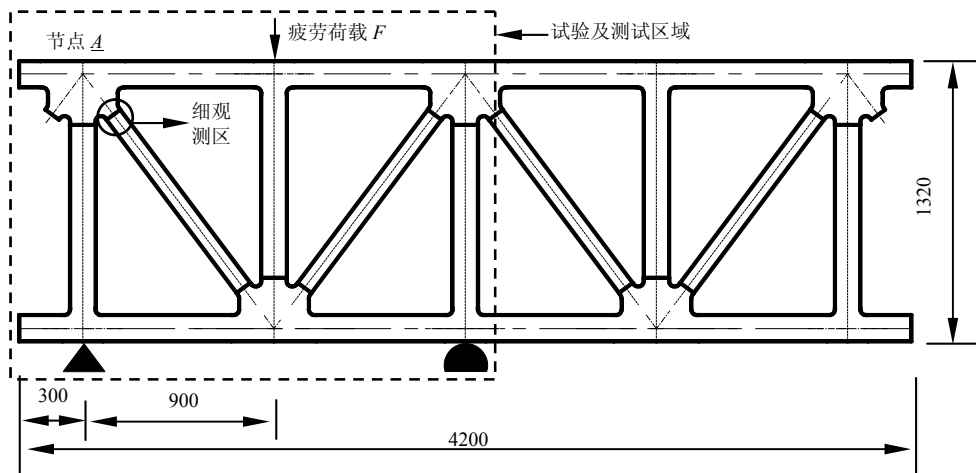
焊接钢桁架结构示意图及试验加载方式 /mm
